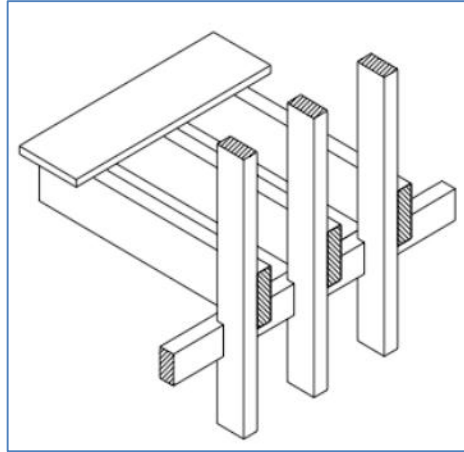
Detalle del encuentro del muro con el forjado en el sistema globo
